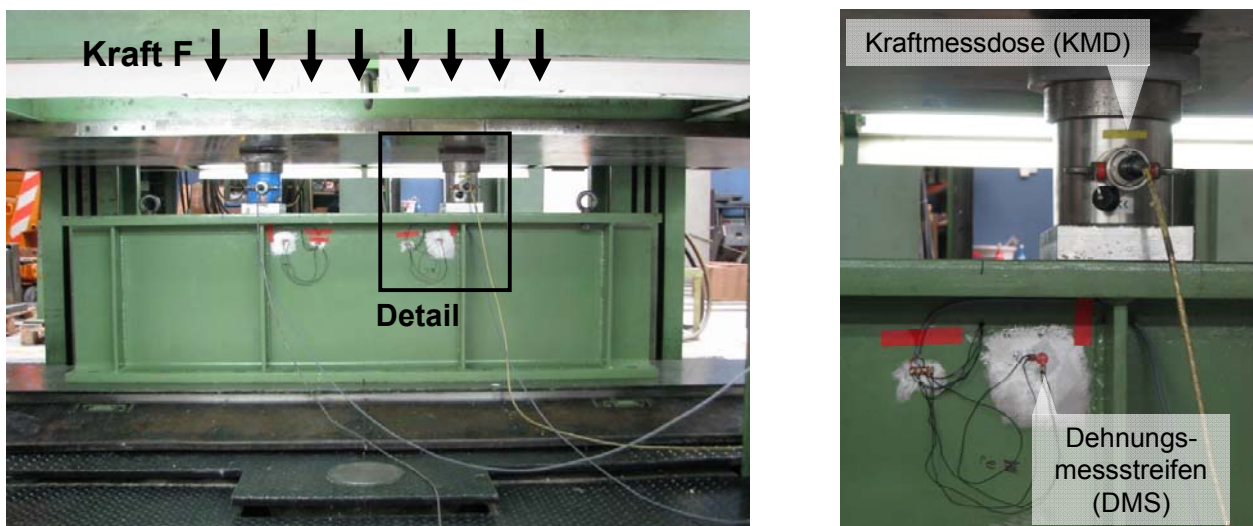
Versuchsaufbau zur Untersuchung des Tragverhaltens der Kopplung zweier Stahlbetonplatten (realmaßstäbliches, ebenes Tübbingmodell)
